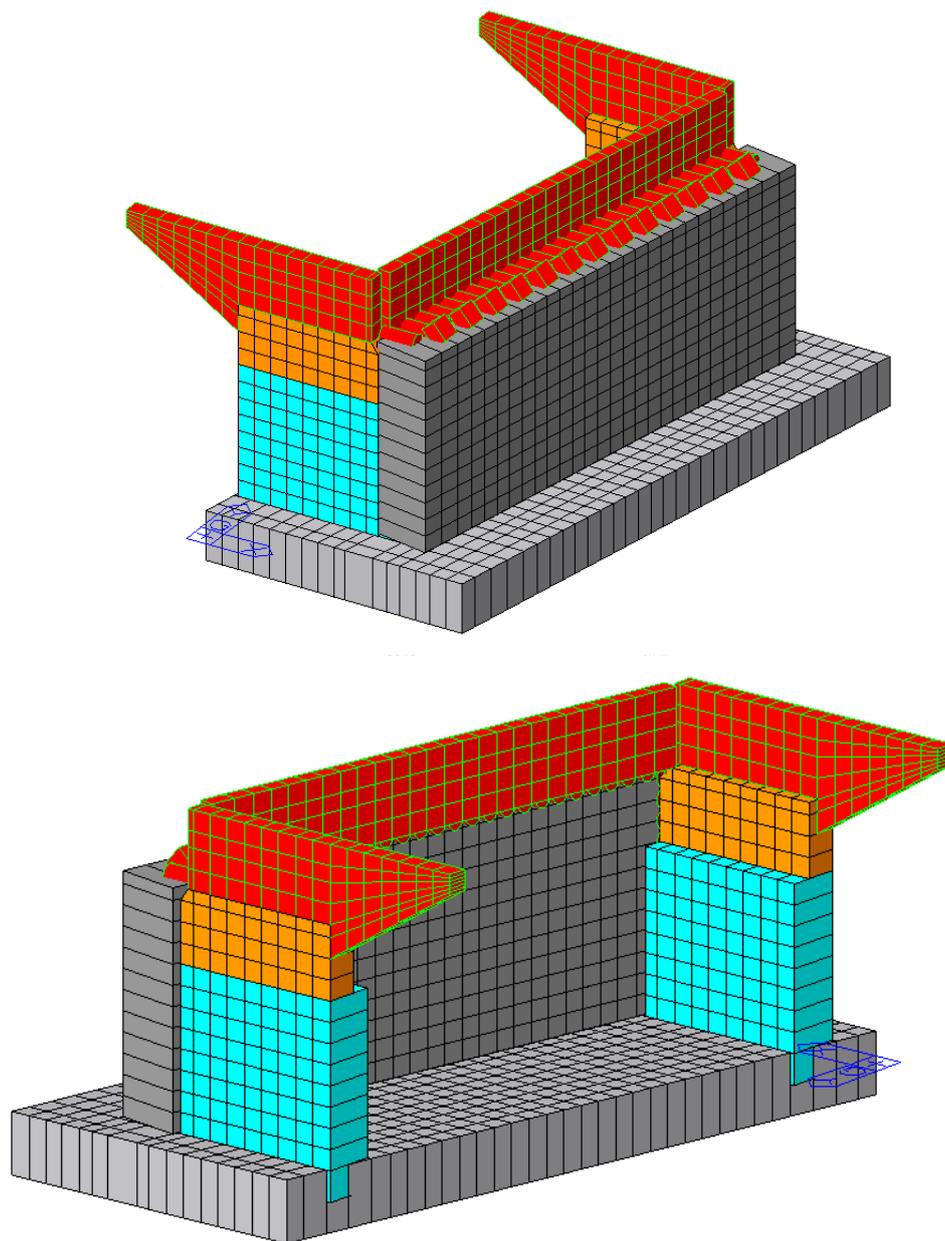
Modello 3D spalla S1-Fissa
